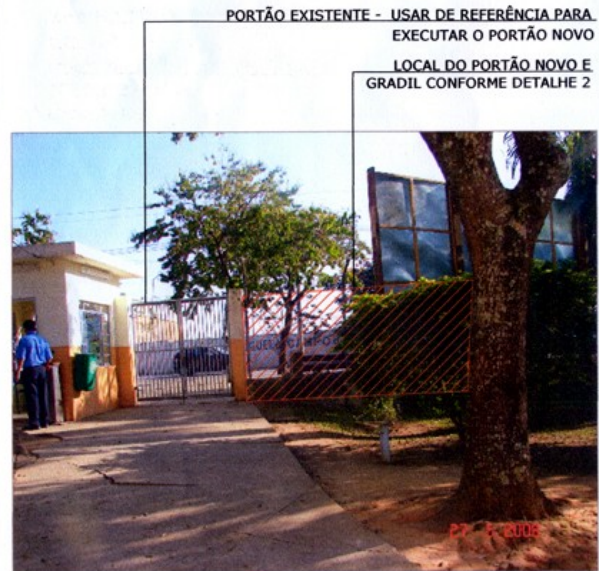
LOCAL DO PORTÃO NOVO HACHURADO
